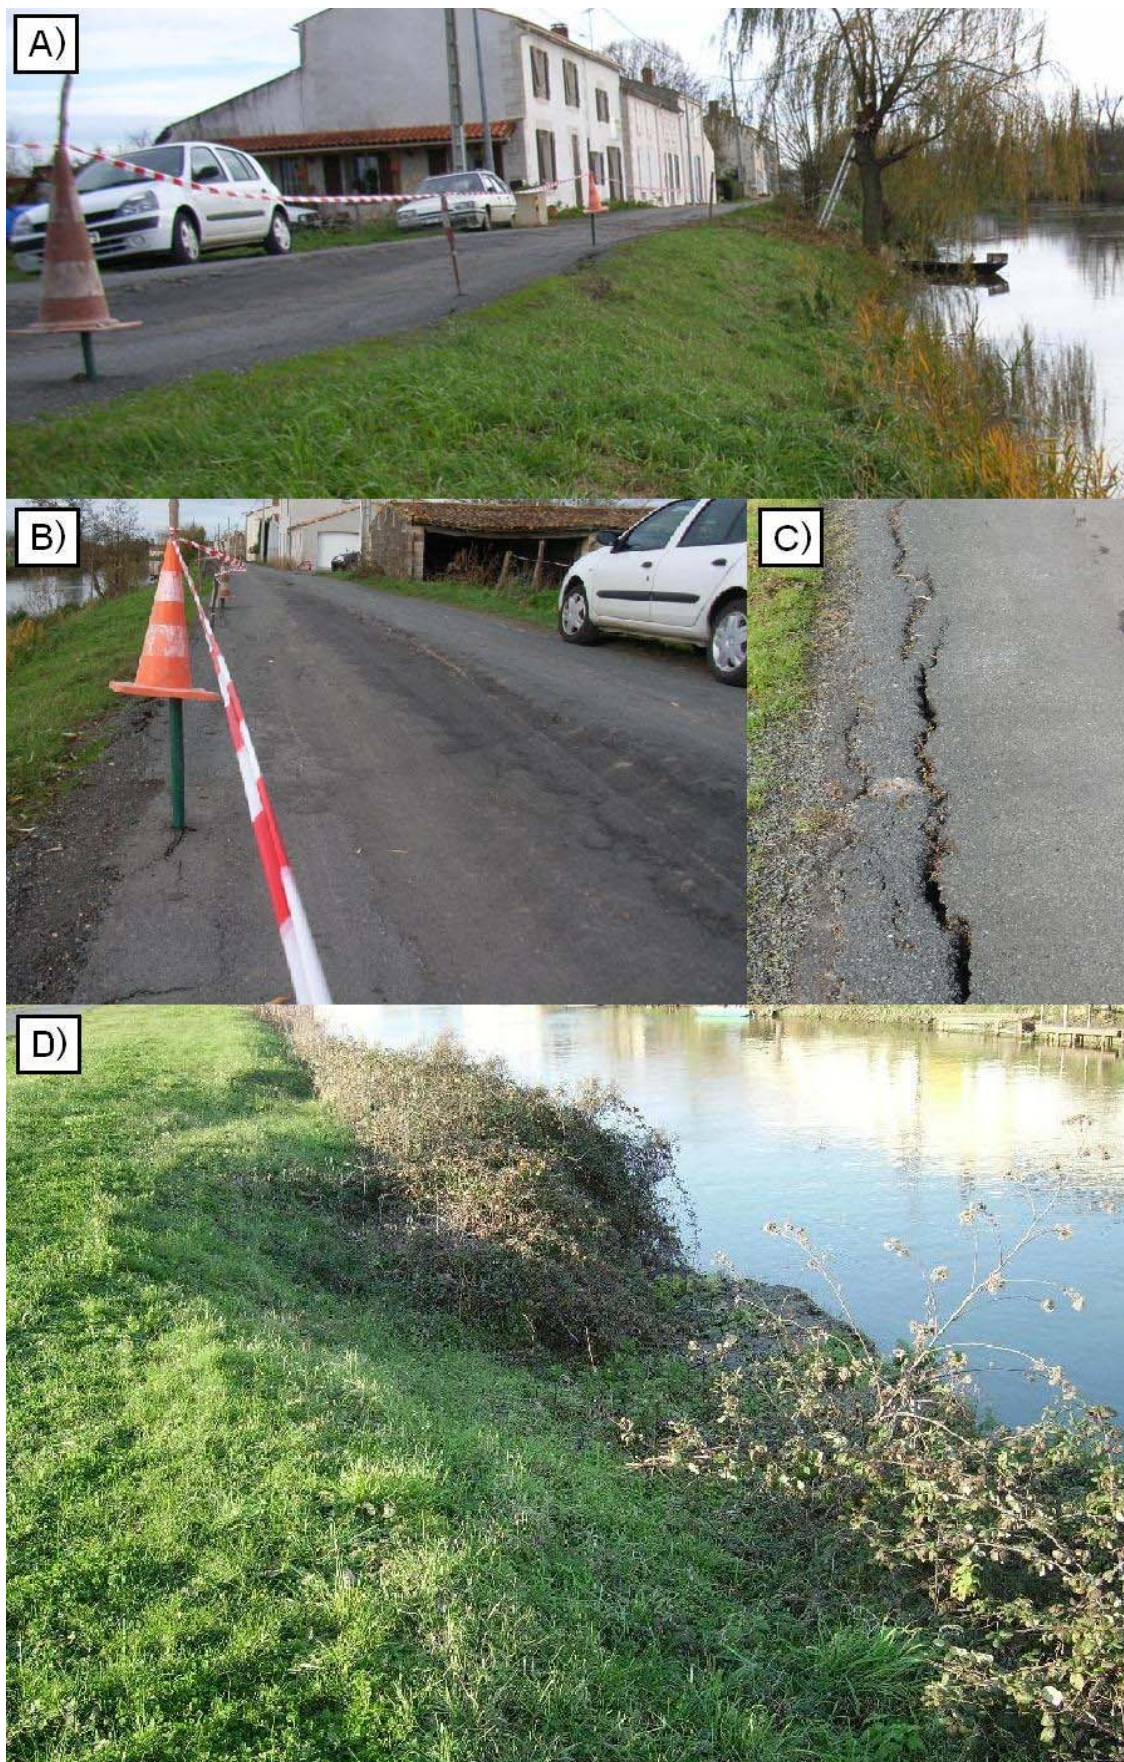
Degradations observées à Damvix : A et B) déformations de la chaussée (Photos IIBSN) ; C) fissurations ; D) glissement rotationnel
